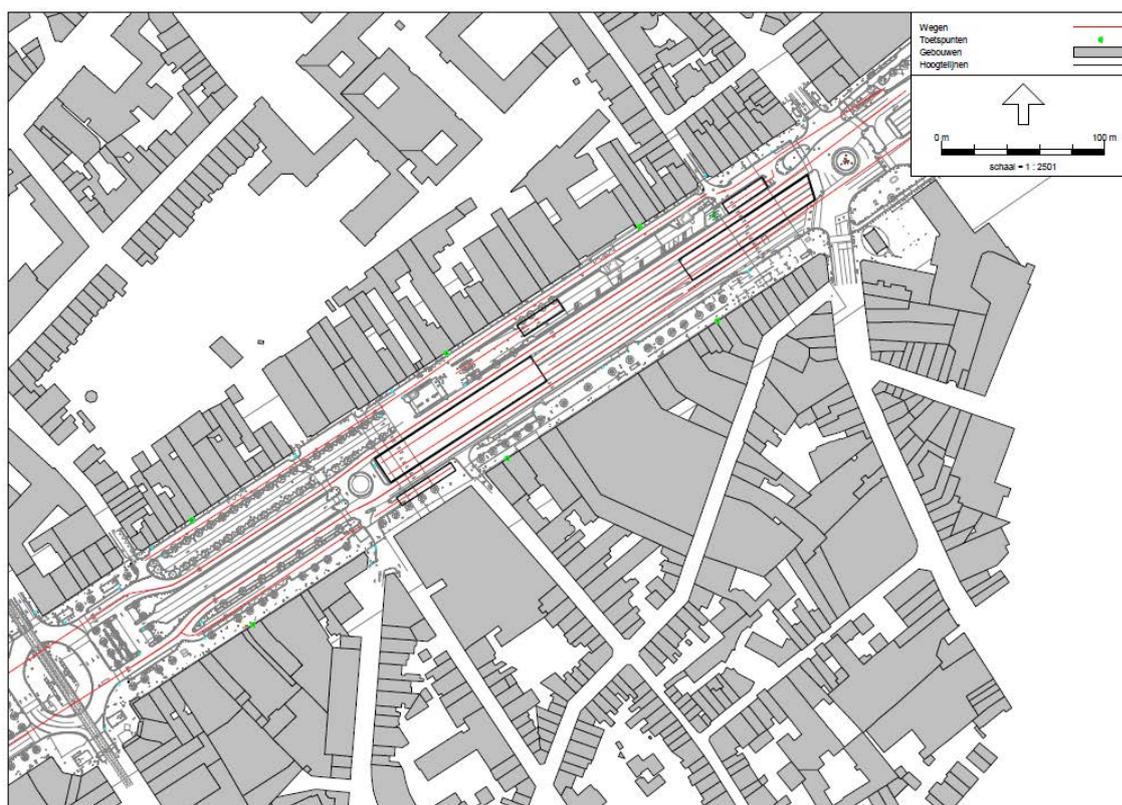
Plan de la circulation situation existante (Source : POLO)
